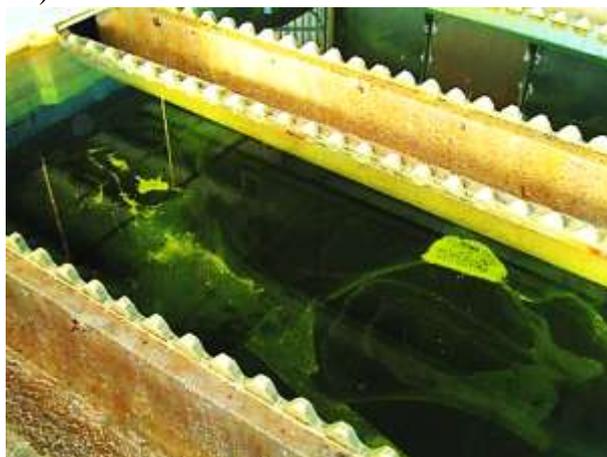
Визуальное обследование фильтровальной станции ОСВ (здание 22)
